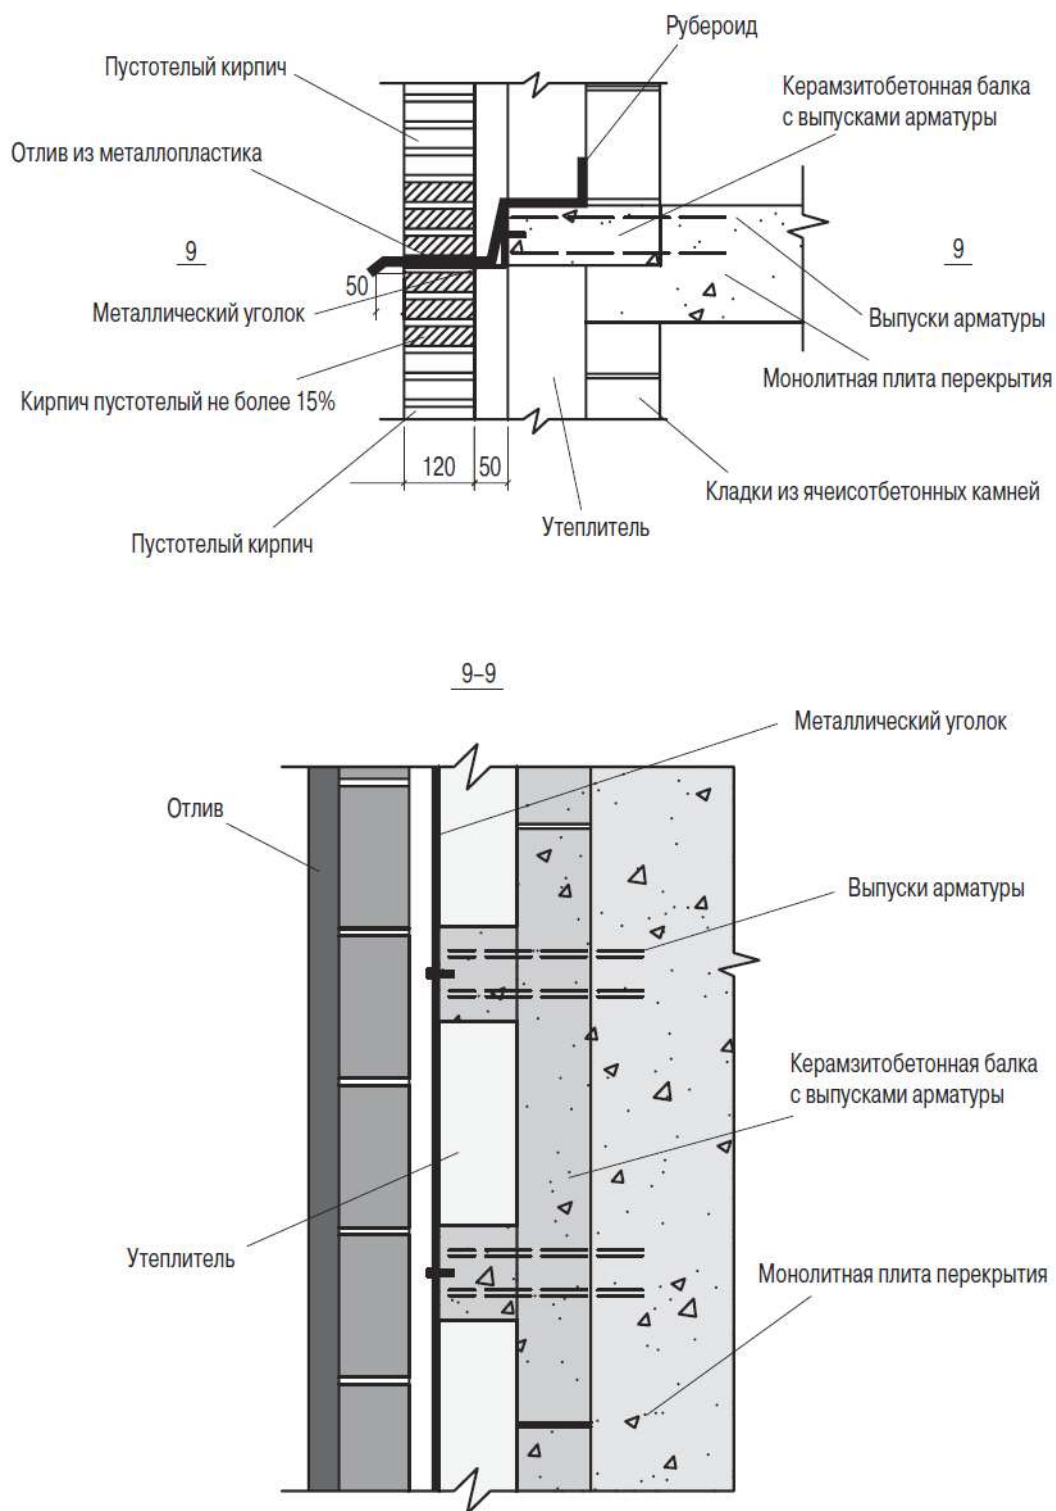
Схема устройства отлива в уровне перекрытия при опирании наружного слоя на уголок, крепящийся к керамзитобетонной балке. Разрез 9-9
